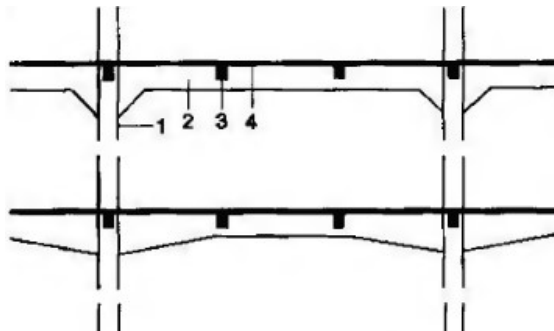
Монолітний залізобетонний каркас з головними балками-ригелями змінного перерізу
